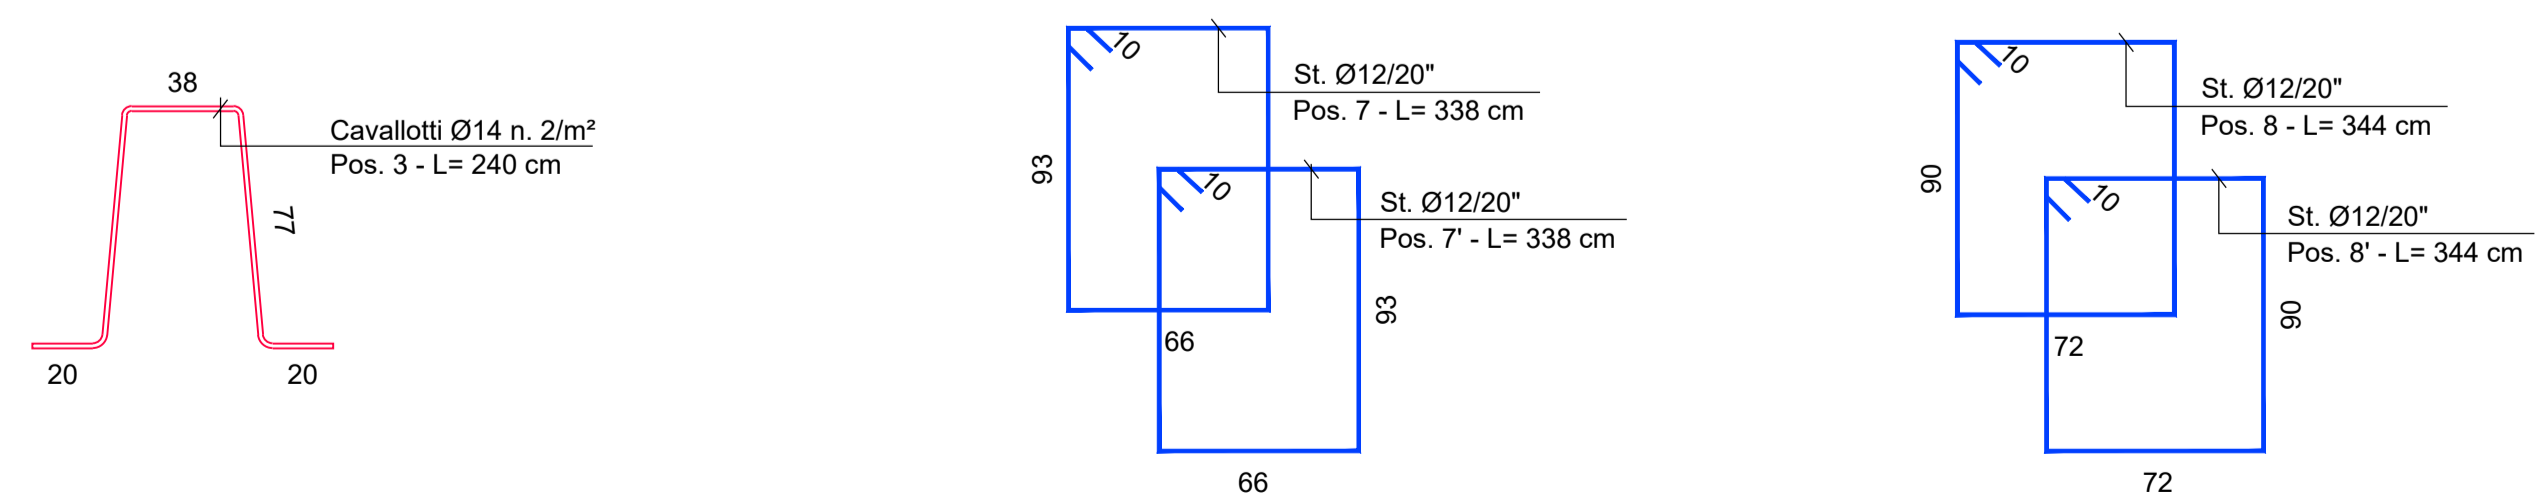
PLATEA IN C.A. STRALCIO PIANTA ARMATURA
